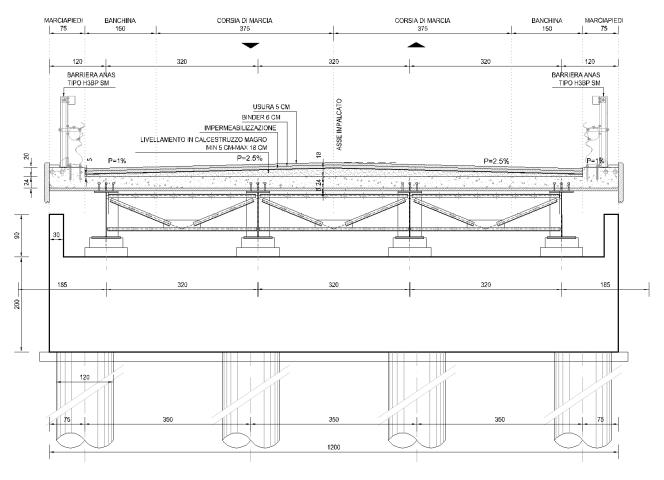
SEZIONE TIPICA IMPALCATO (SU SPALLA)
